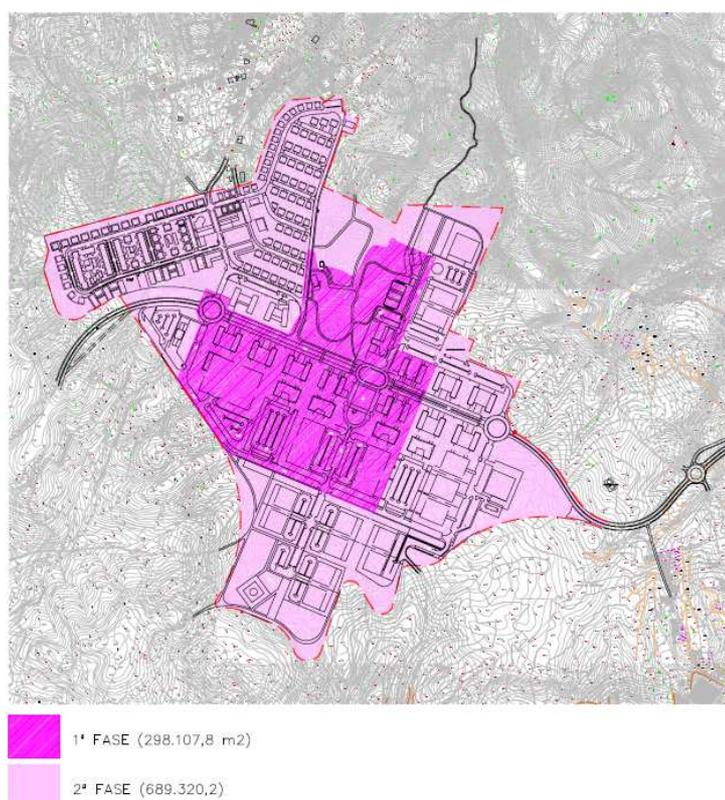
Área do Plano de Pormenor e o loteamento da 1ª. Fase
